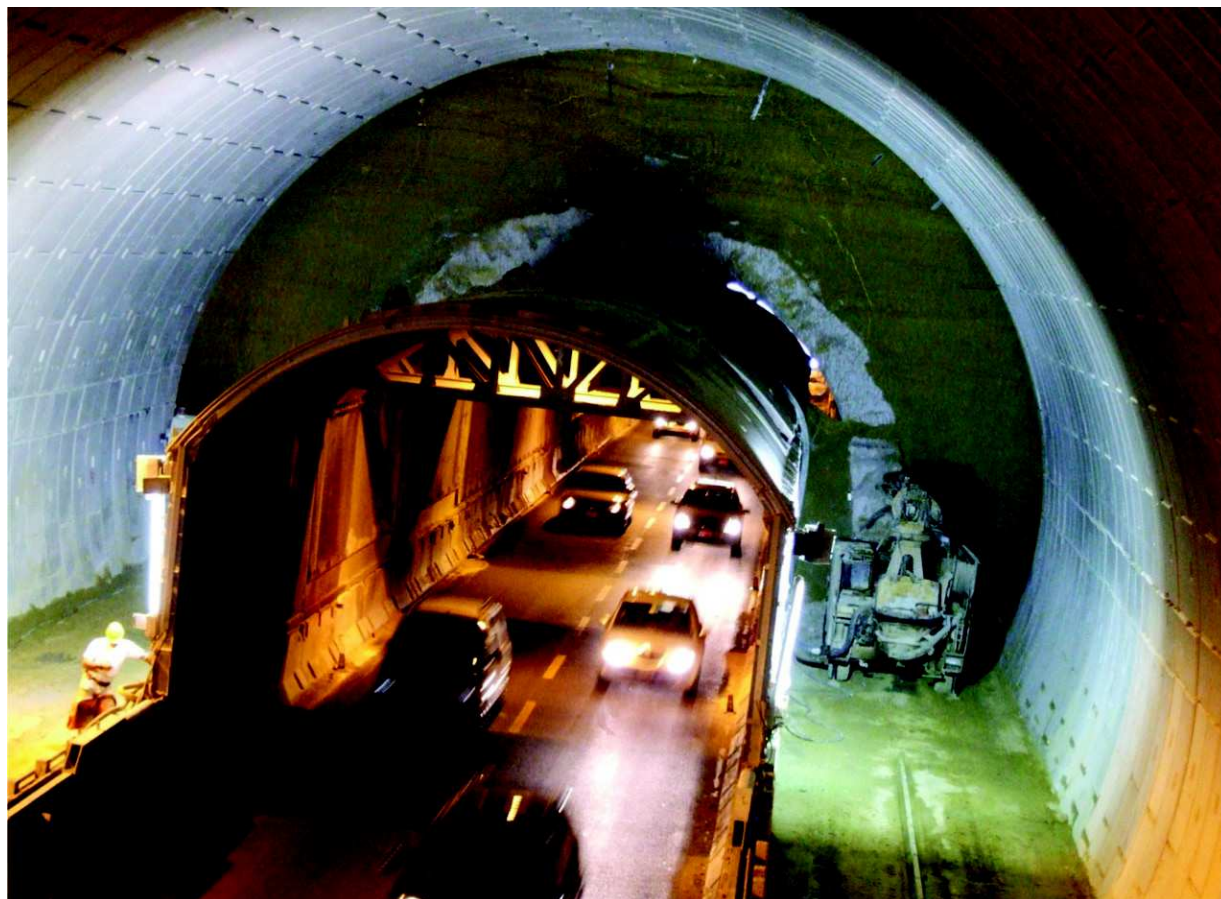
Galleria Nazzano: il flusso veicolare che scorre sotto lo scudo di protezione del traffico durante le lavorazioni di allargamento della galleria.
